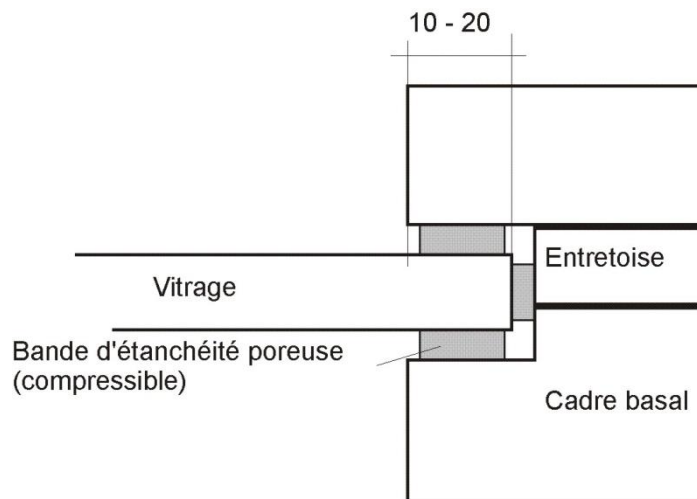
Configuration d'essai d'un vitrage enserré dans un cadre, vue en coupe (dimensions en milli-mètres)
